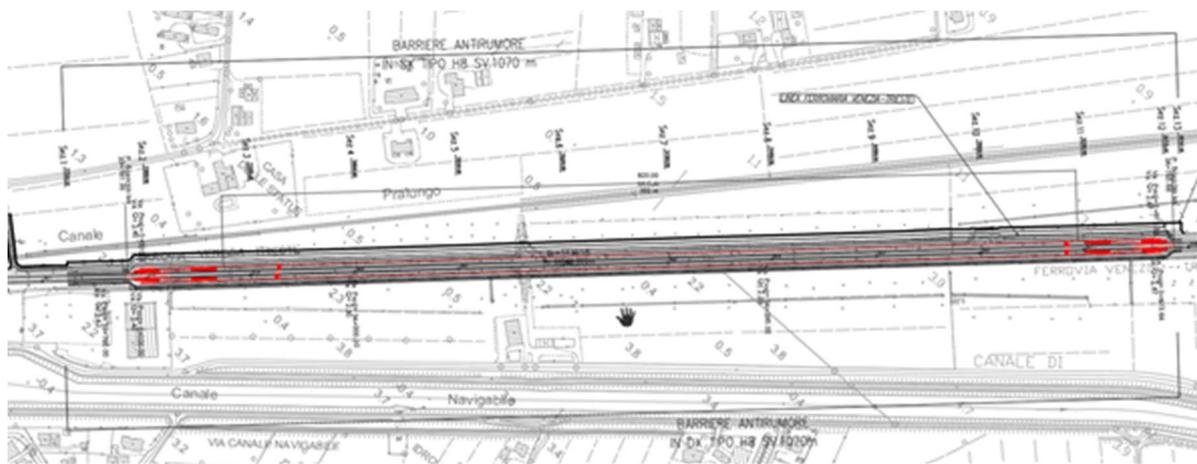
Stralcio planimetrico del nuovo Posto di Movimento di San Donà
